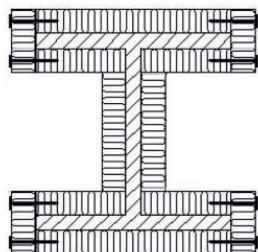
Схема устройства покрытия по поверхности металлической конструкции [1]
